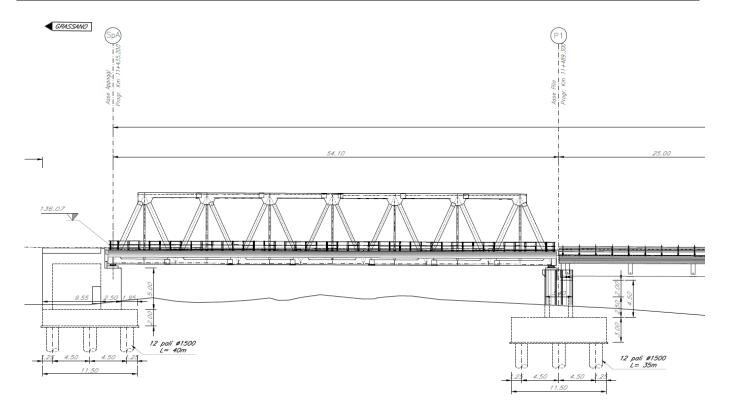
Spalla cava e pila scatolare singolo binario – prospetto longitudinale
